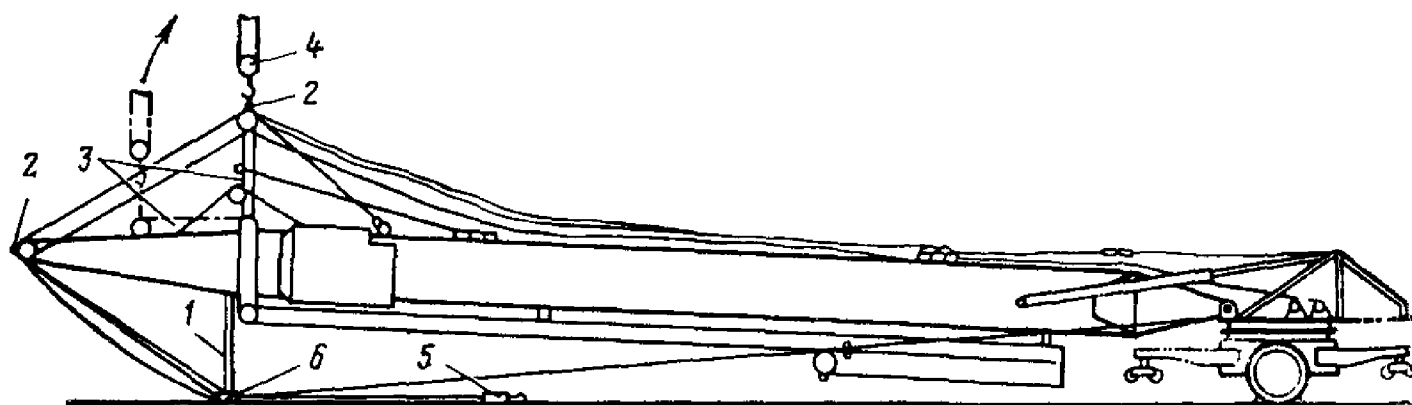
Схема установки башни на ее монтажную стойку:
